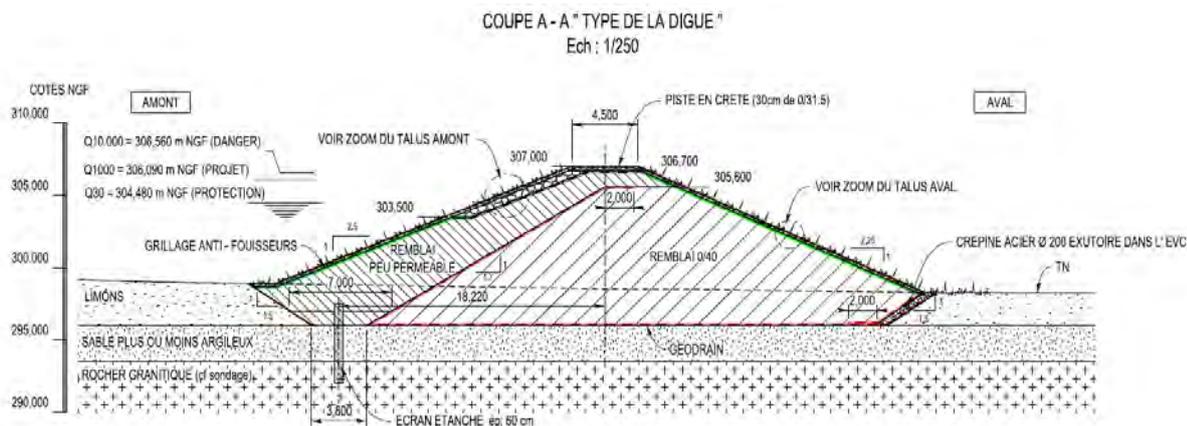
Coupe type du barrage de la Turdine (géodrain en rouge)
